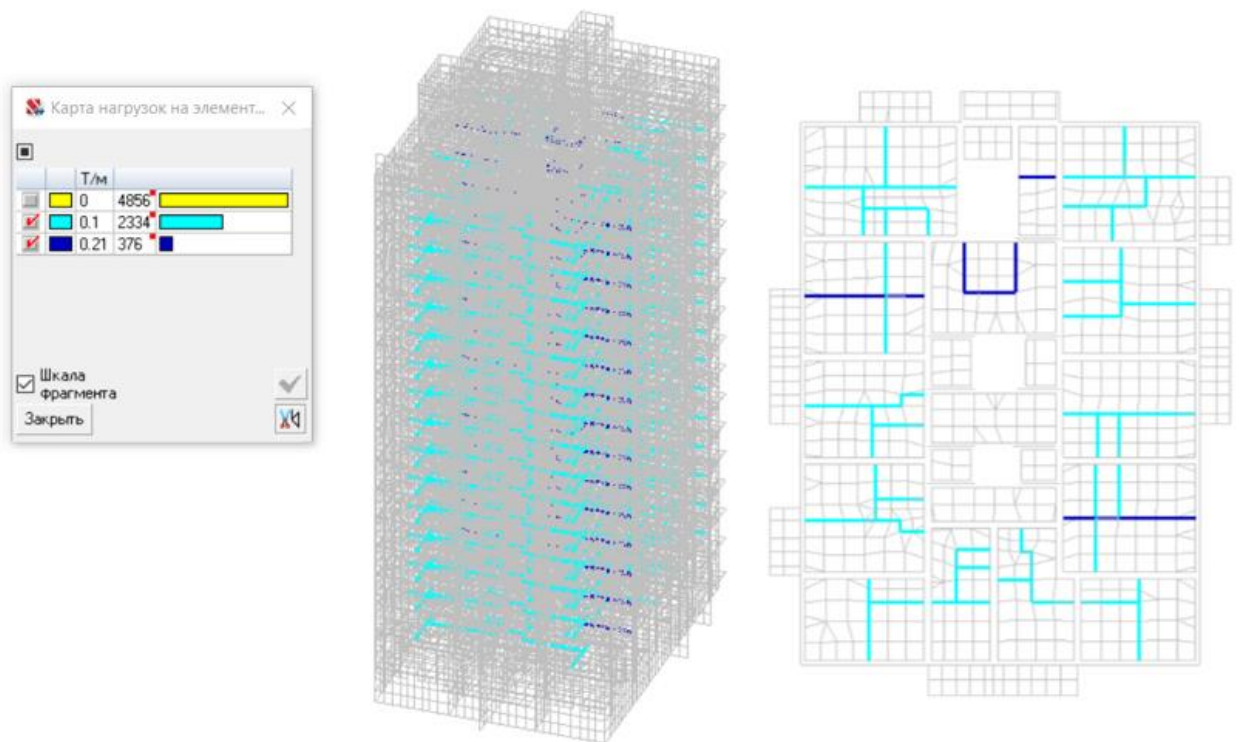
загрузка 5 – вес перегородок фактический (слева – все здание, справа – на один этаж)
